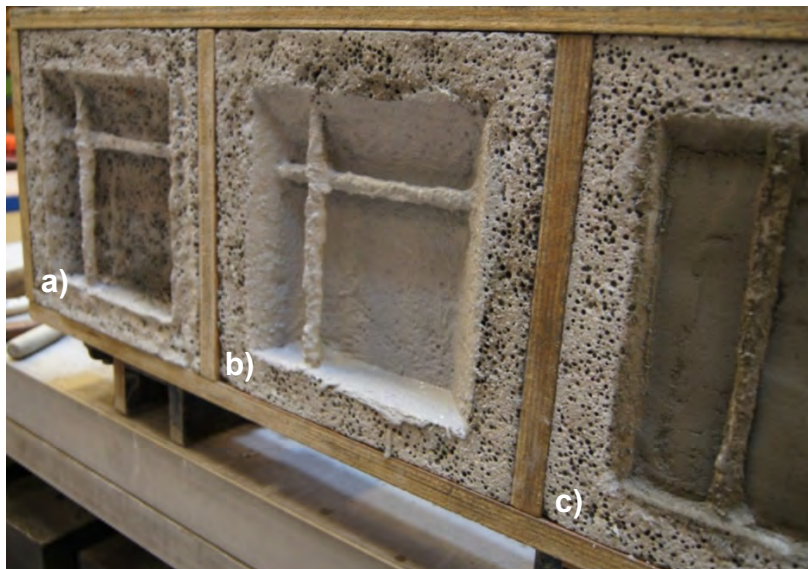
a) Korrosionsschutz; b) Haftbrücke; c) kommerzieller Instandsetzungsmörtel
